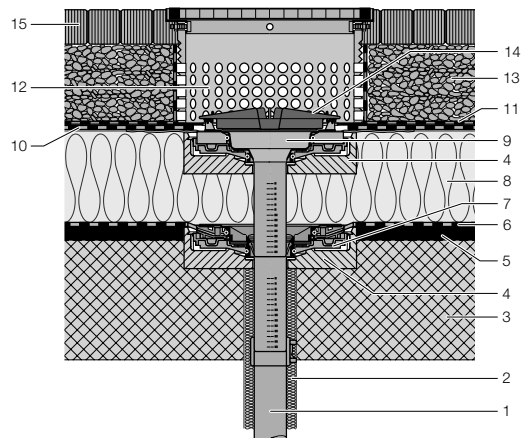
Конструкция монолитной крыши, с пароизоляцией и кровельным покрытием, пригодным для передвижения людей
